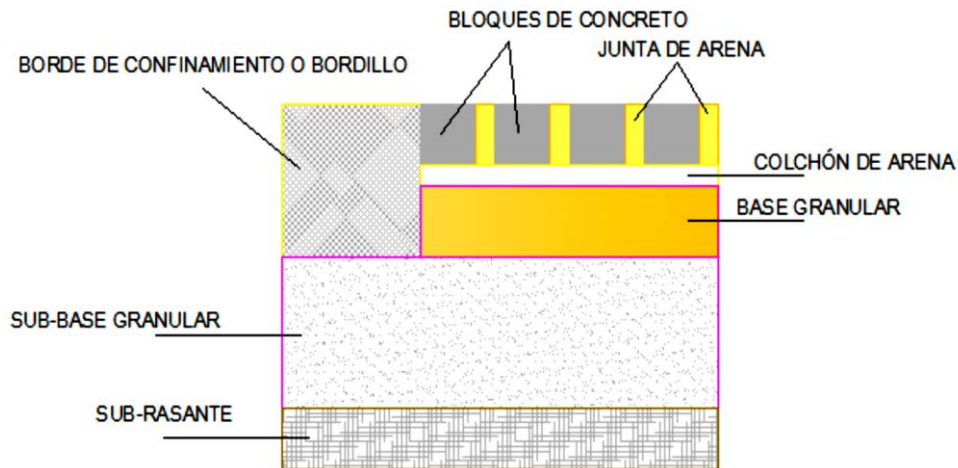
Componentes tradicionales de un pavimento articulado. (Armijos, 2009).
